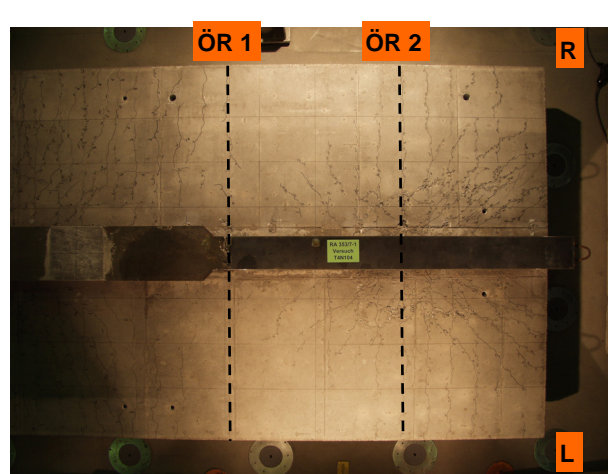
Rissbild auf der Betongurtunterseite
